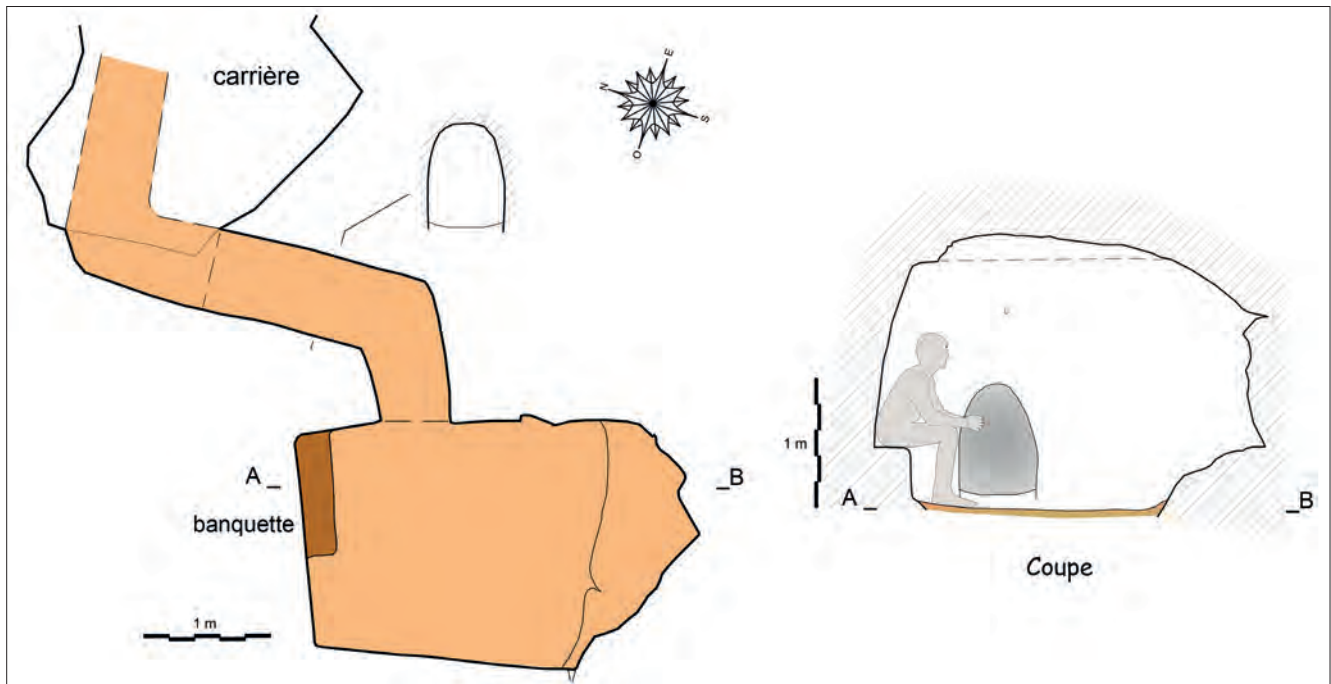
Plan du souterrain de Mardron © Relevé M. Cousin.
